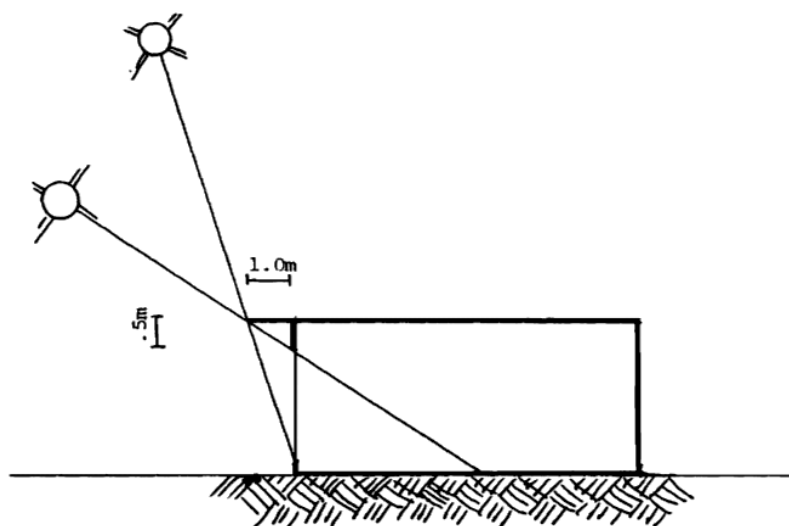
BESTEST: sezione dell'edificio con aggetto ombreggiante le finestre a sud
